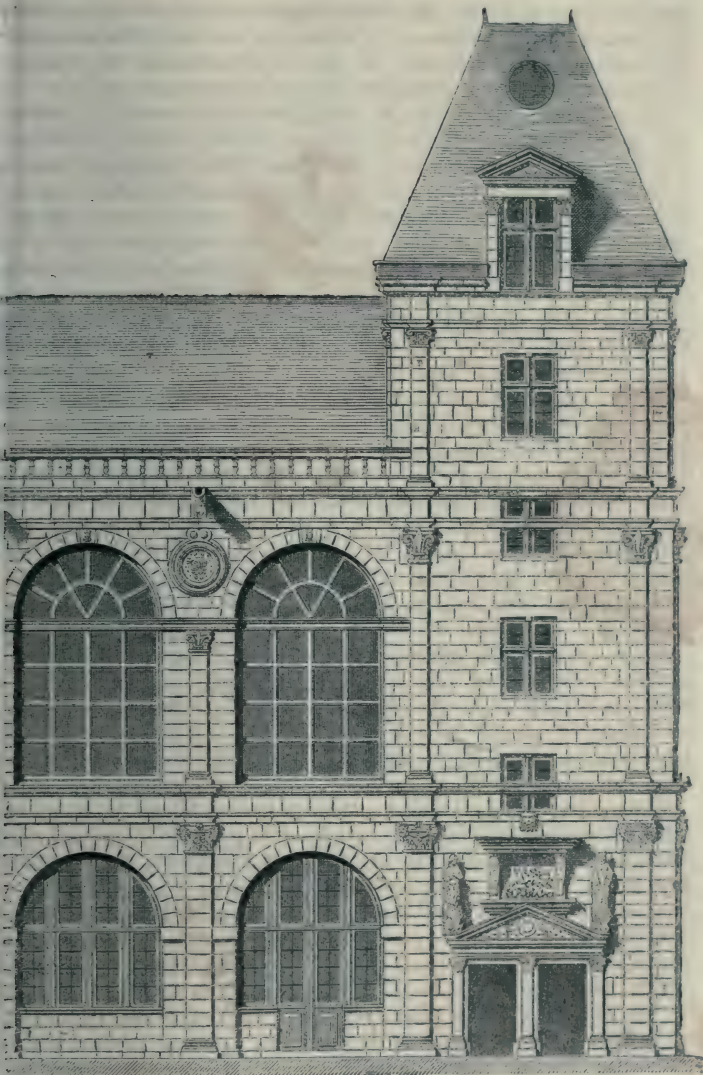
Façade sur la Cour ovale, côté sud. — Tour de l'escalier de la Porte dorée. (Palais de Fontainebleau.)
